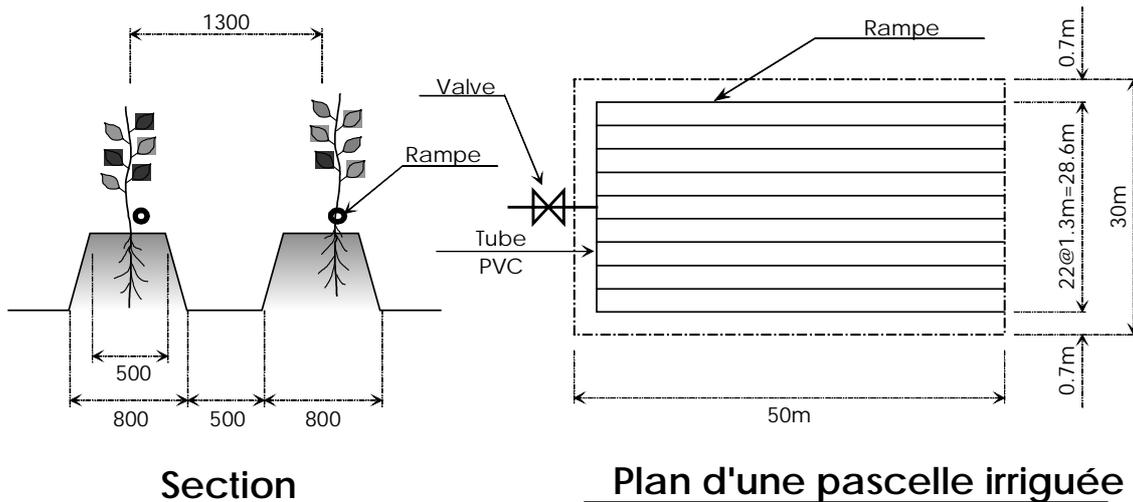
Plan d'irrigation en goutte à goutte
